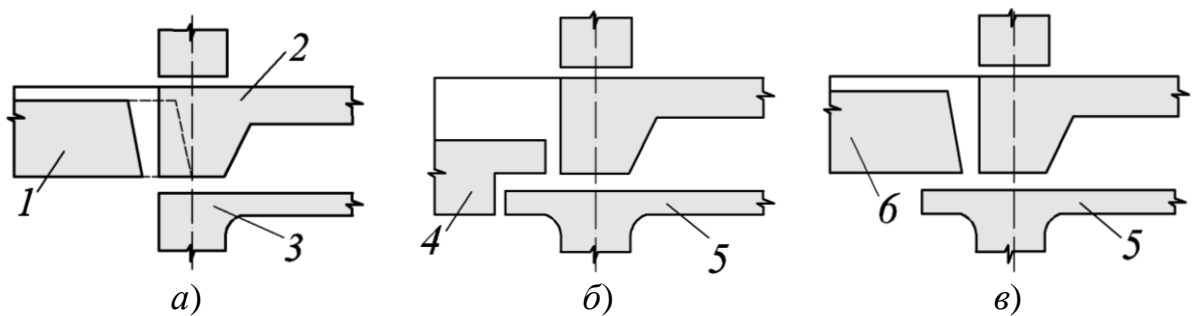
Конструкції горизонтальних стиків плит перекриття з об’ємними блоками в панельно-блокових будівлях:
